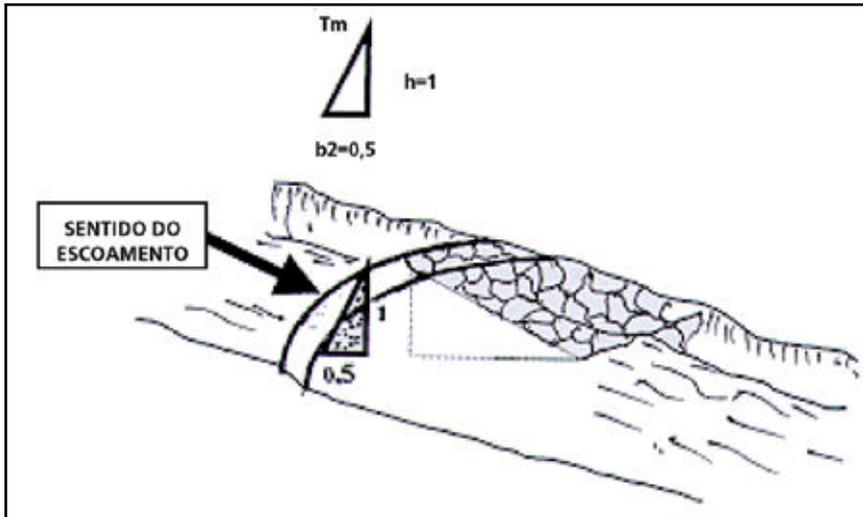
Estrutura e Dimensões do Talude à Montante de uma Barragem de Pedra
